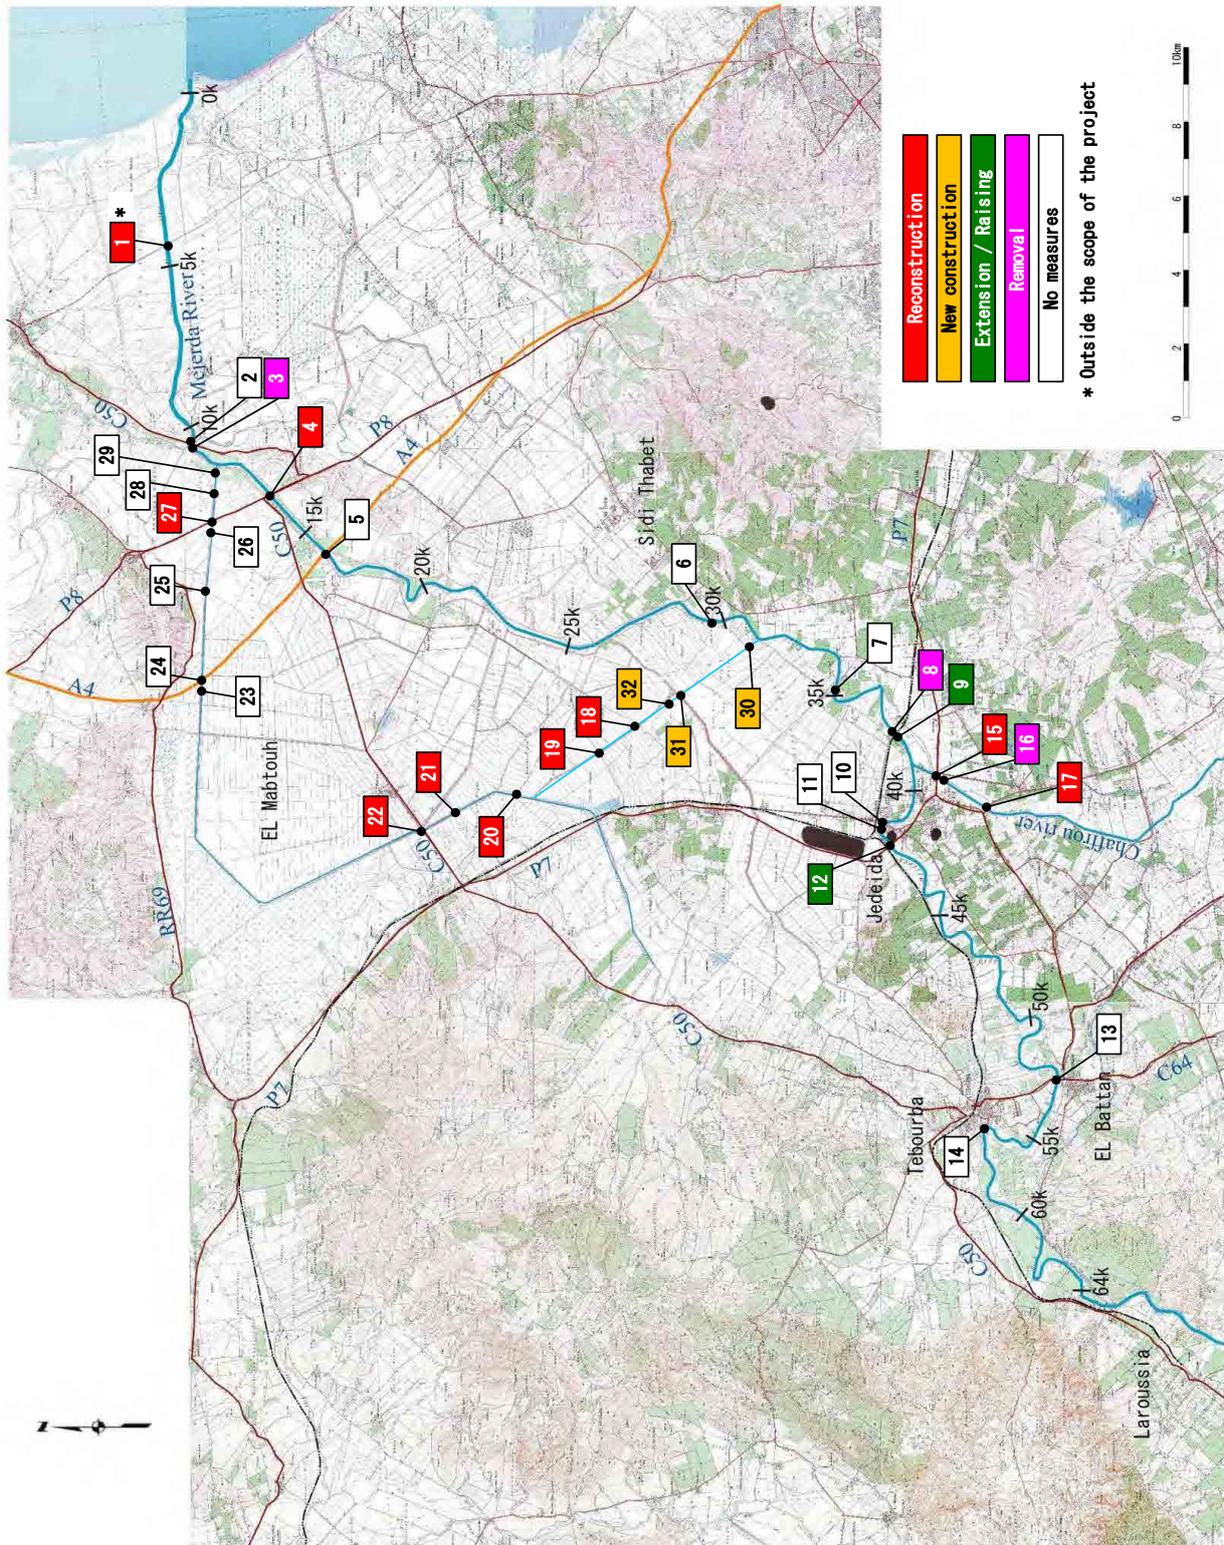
Plan de situation des ponts à aménager et à construire
